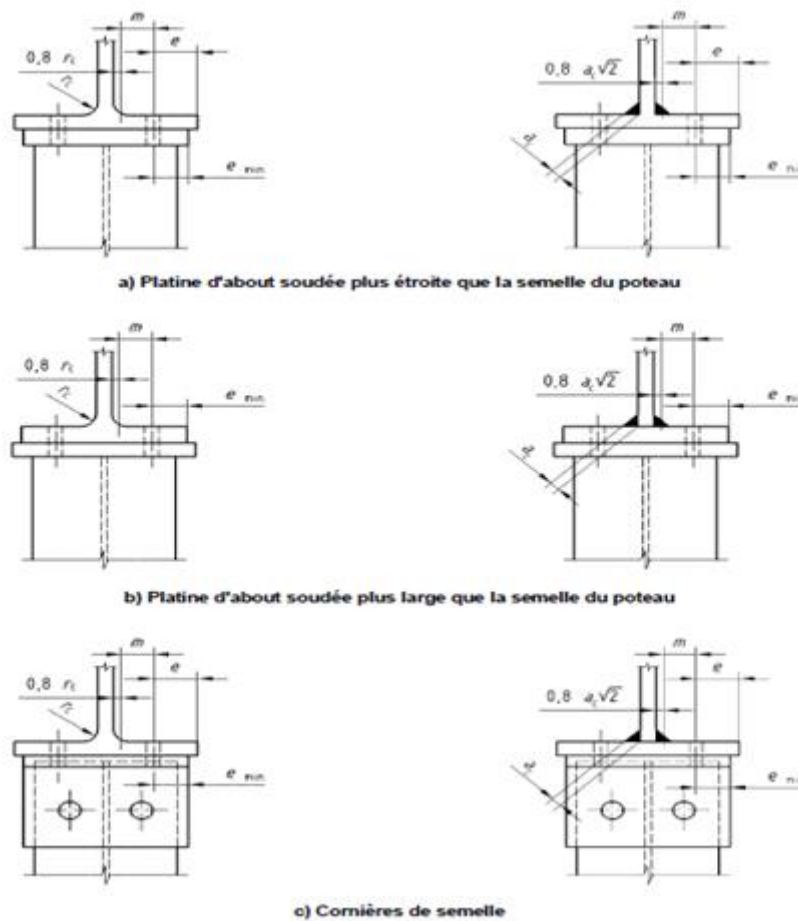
Dimensions e_{min} et m pour une semelle de poteau
